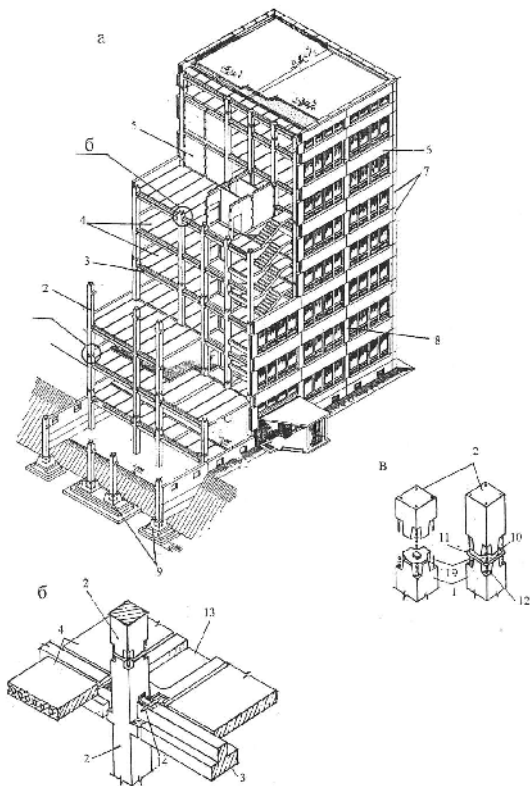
Каркасное здание серии 1.020 - 1: а - аксиометрическая схема конструкции здания; б - узел сборки перекрытия около колонны, в - узел стыковки колонны; 1, 2 - колонны одноэтажные (1) и двухэтажные (2); 3 - ригель; 4 - плиты перекрытия; 5 - стенки диафрагмы жесткости; 6, 7, 8 - стеновые панели поясные(5), угловые (7) и прогеселенные (8); 9 - фундаментные конструкции; 10 - выпуски арматуры колонны; 11 - стальной хомут; 12 - бетон замоноличивания; 13 - панель - распорка перекрытия; 14 - стальные соединительные детали
